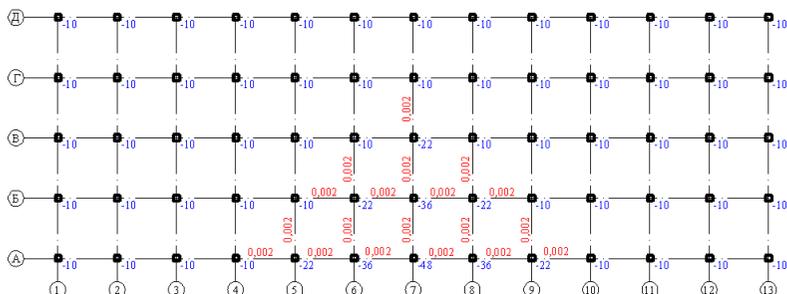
Расчетная схема здания при заданных сочетаниях осадок (осадка центральной и крайней части фундамента)
